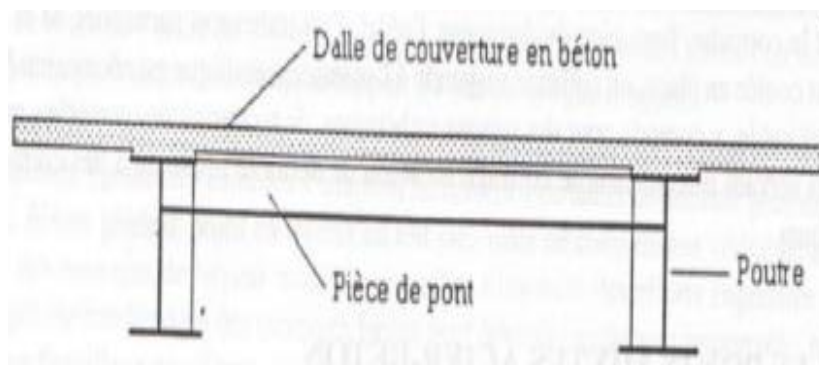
les composantes d'un pont bipoutres-mixte à pièces de pont [1].
